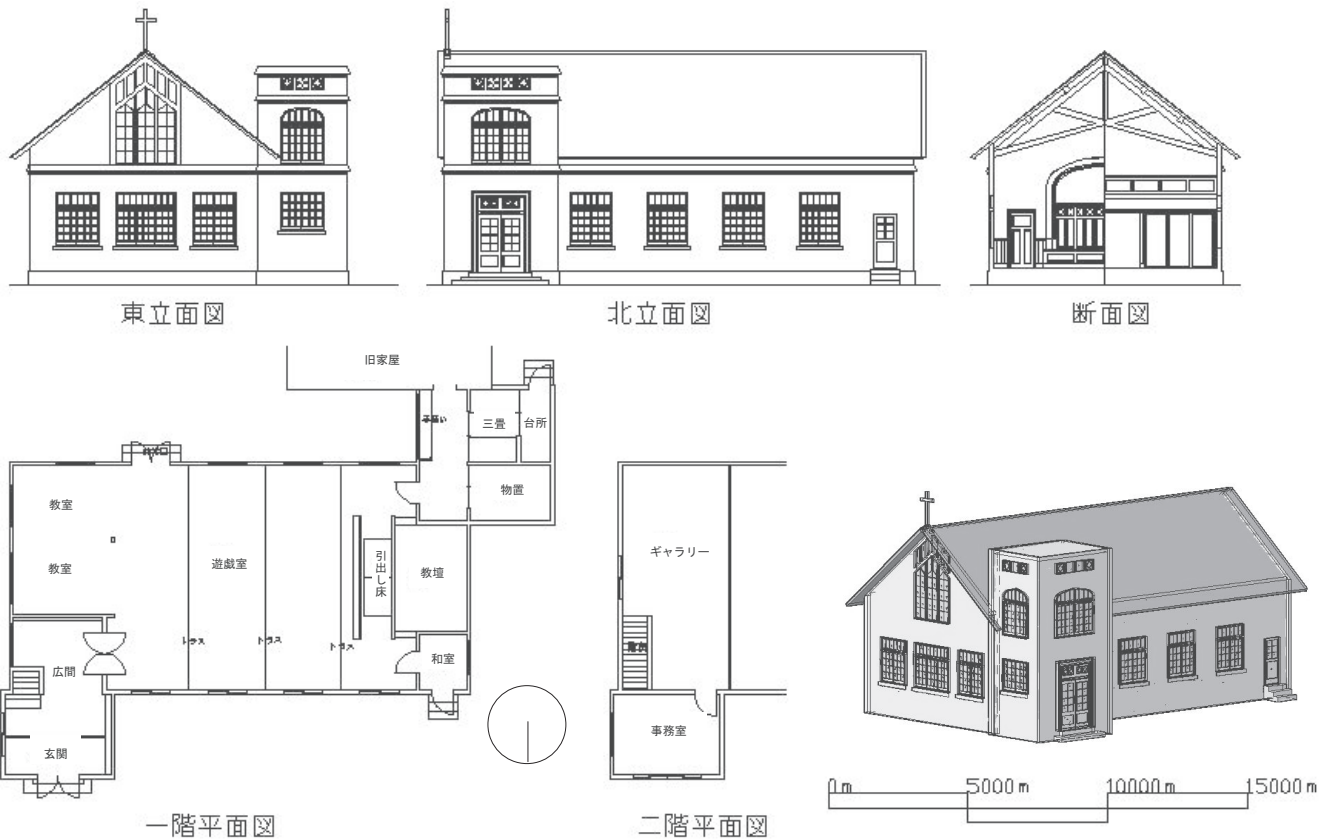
第二期教会堂時代 平面図・立面図・断面図・3D モデリング
